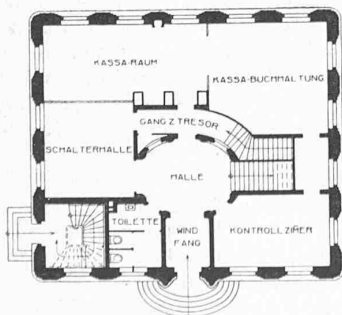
Erdgeschoss. — Masstab 1 : 400. —
